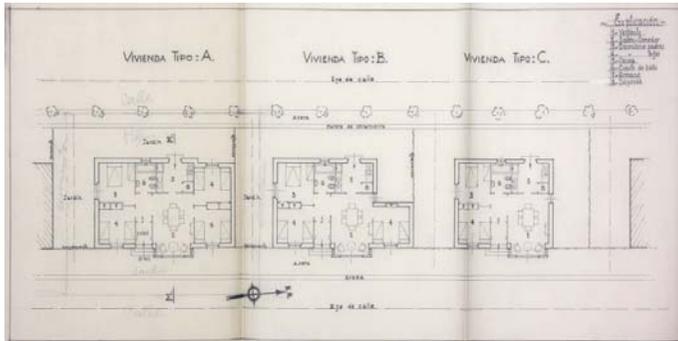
Plano de proyecto para las viviendas para el Grupo "Segarra" de Mayo de 1942.
